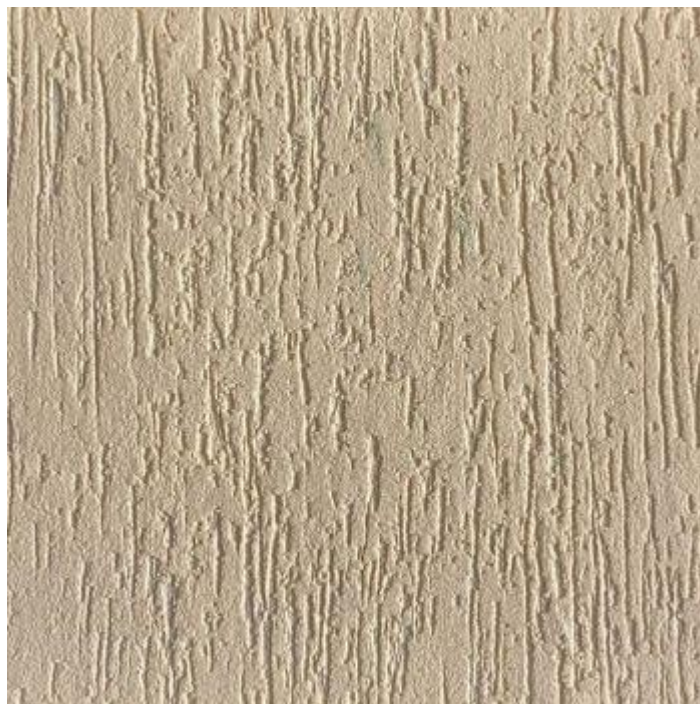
Acabamento troiado para fachada frontal e marquise da porta de entrada.
